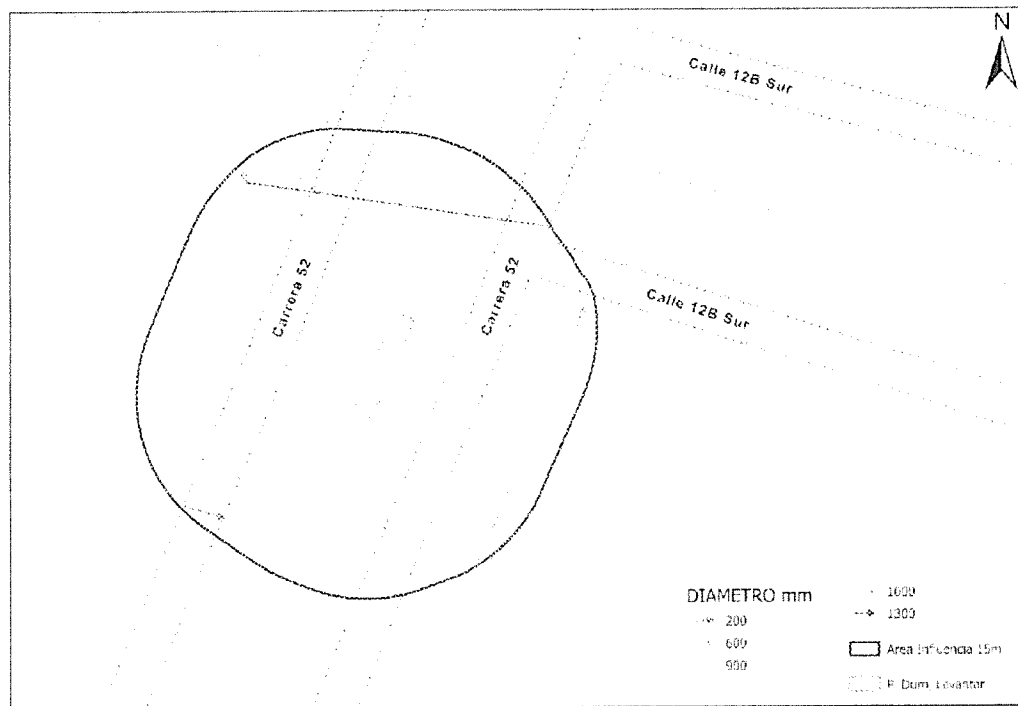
Distribución espacial por diámetro para la red de alcantarillado.
